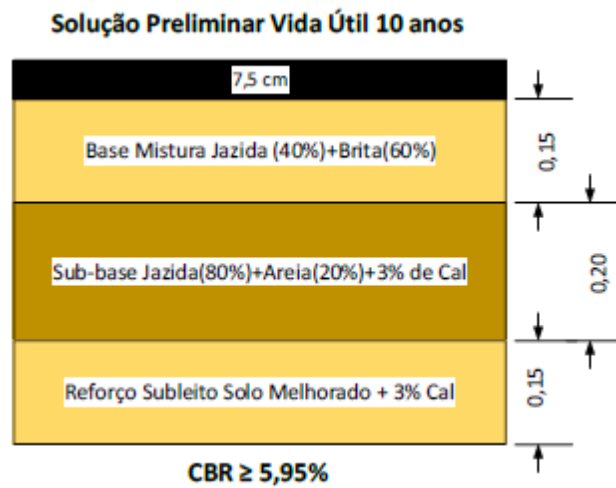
Seção Típica Pavimento Vida Útil 10 anos
